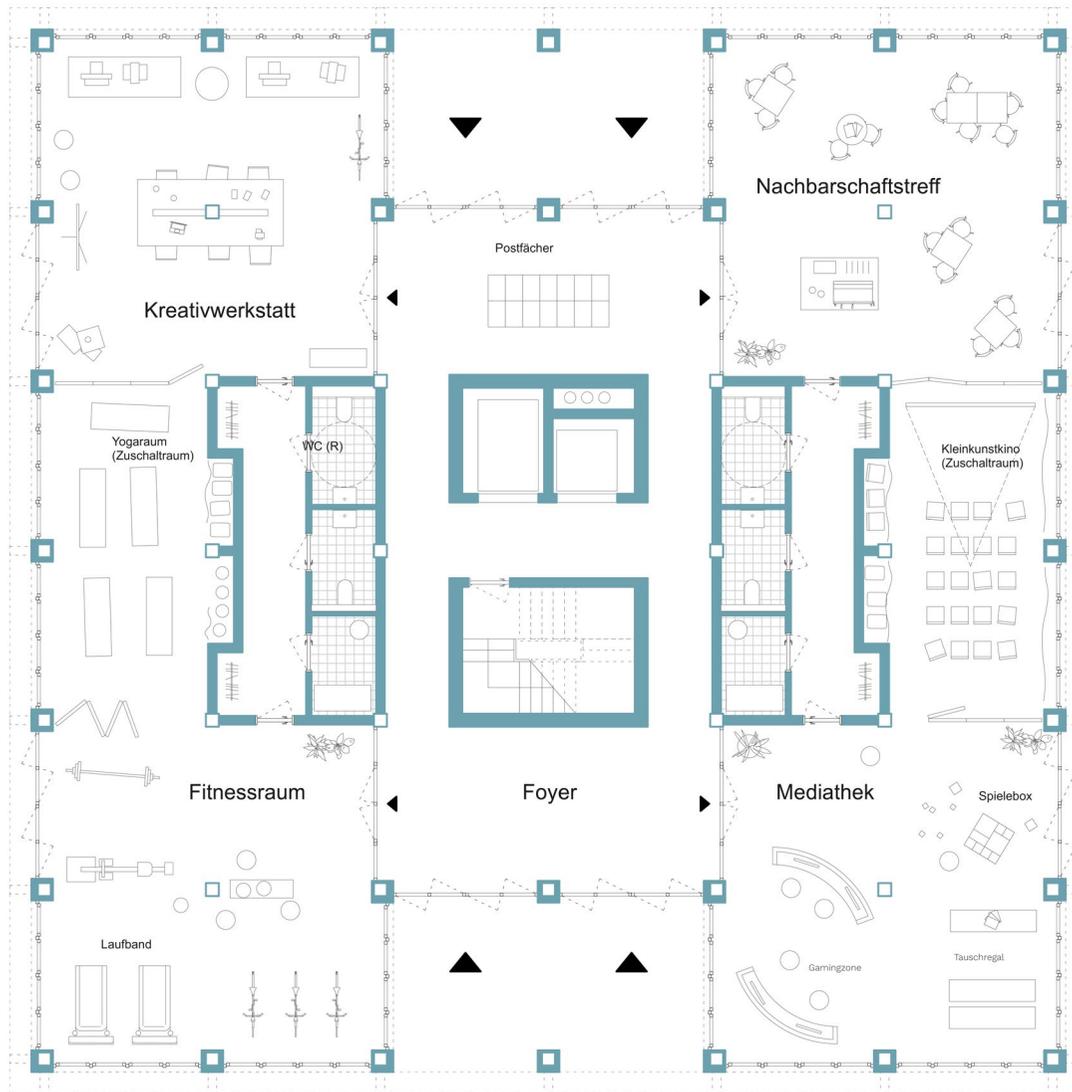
Erdgeschoss | M 1:175 | Studio ELE (Köln)
